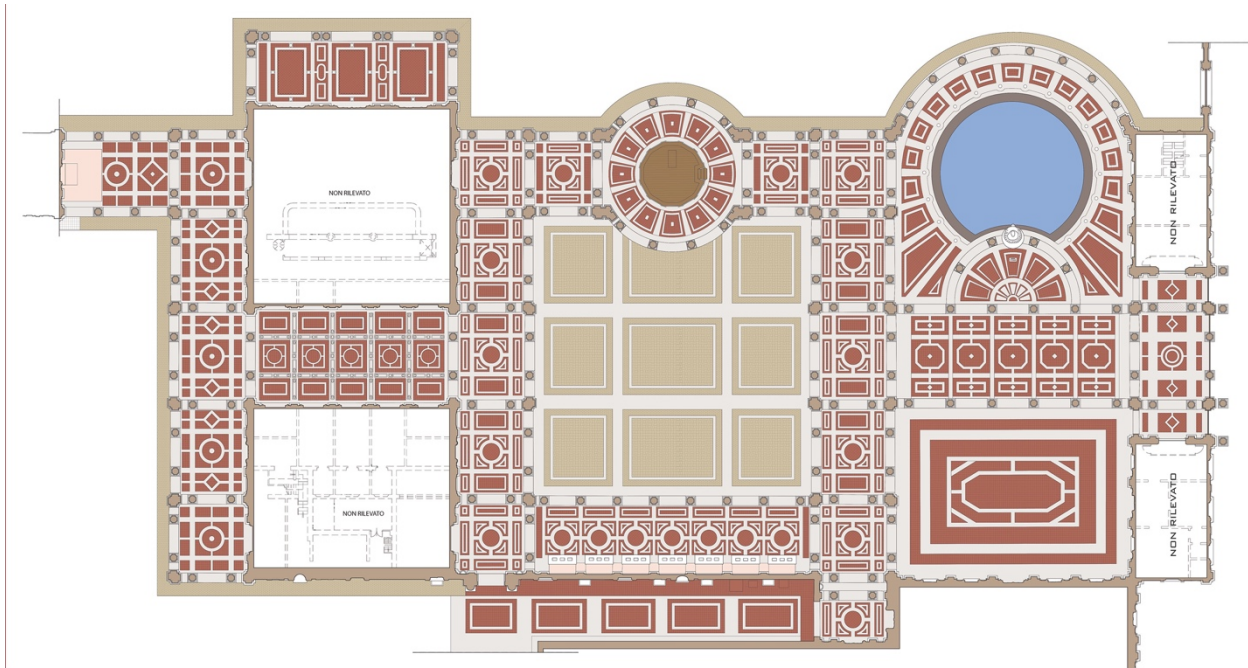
Pianta delle terme Tettuccio (disegno di AP 2021)
